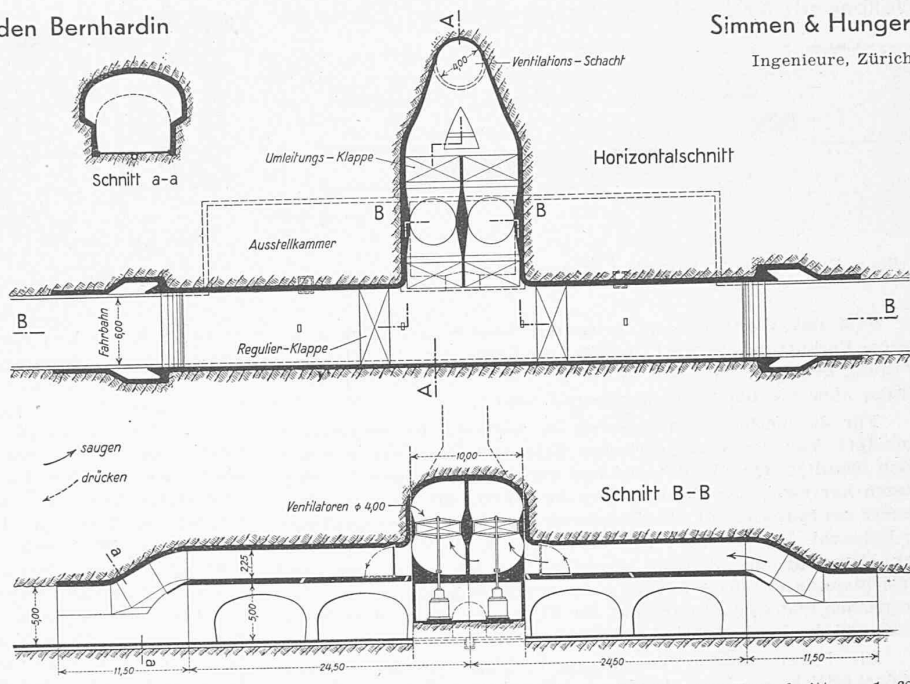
Längs- und Querschnitte der Ventilationsanlage mit Schacht in Tunnelmitte, — 1:600
